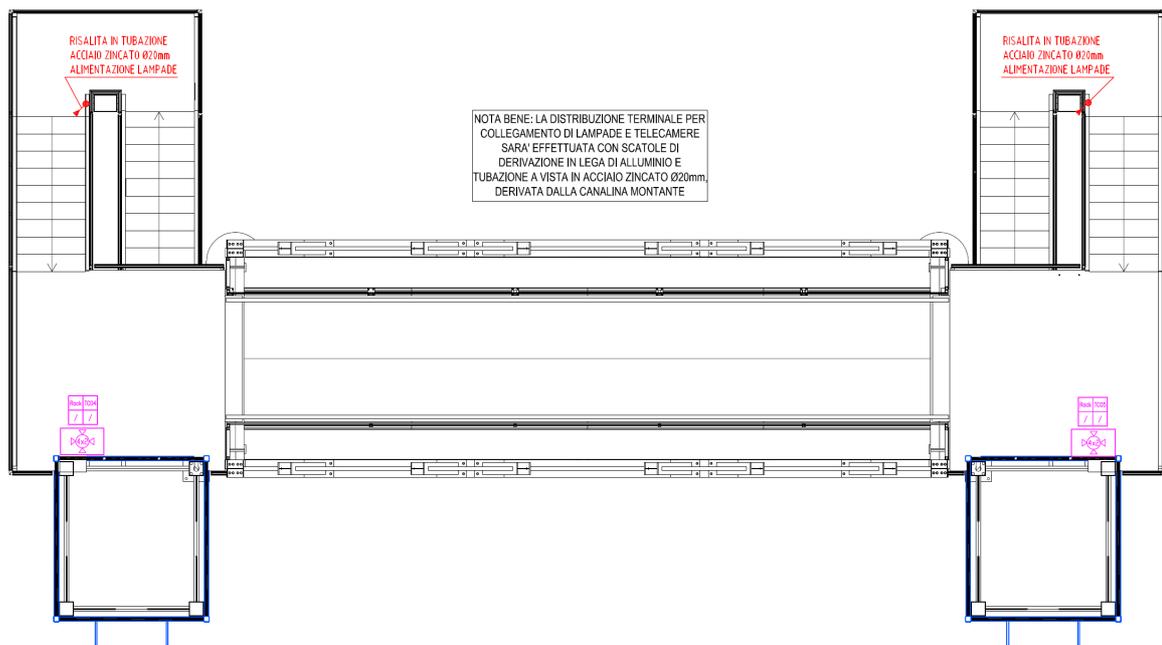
Estratto impianto tvcc planimetria impalcato passerella
